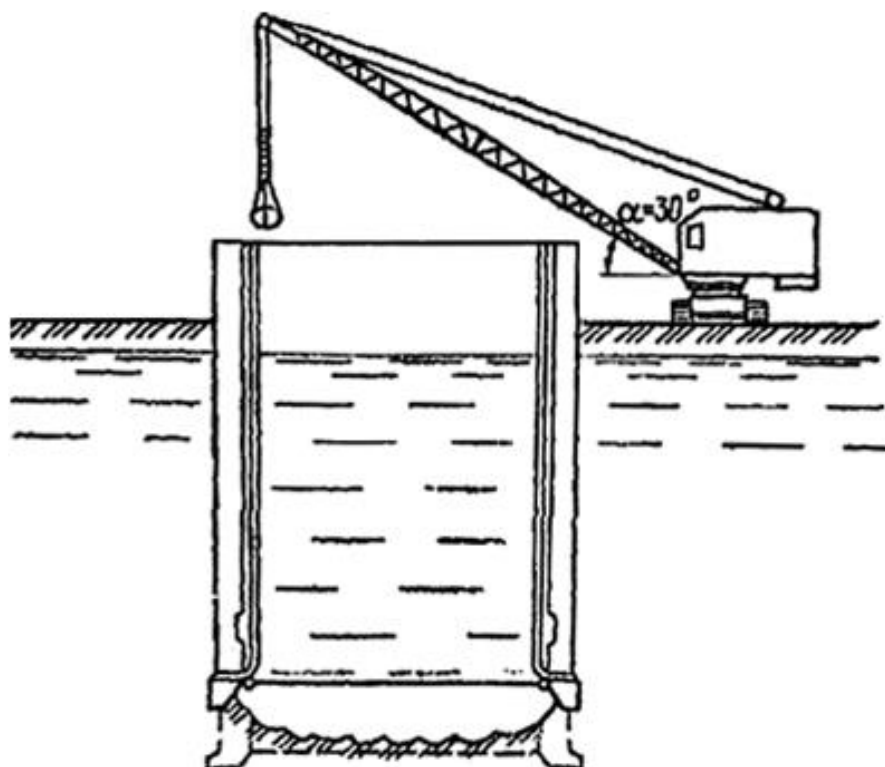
Схема опускания колодца с выемкой грунта из-под воды
